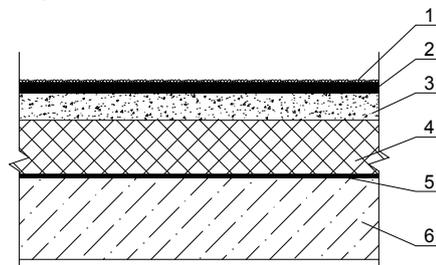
Совмещенная кровля, в которой все слои последовательно уложены на несущую конструкцию и покрыты водоизоляционным ковром:
